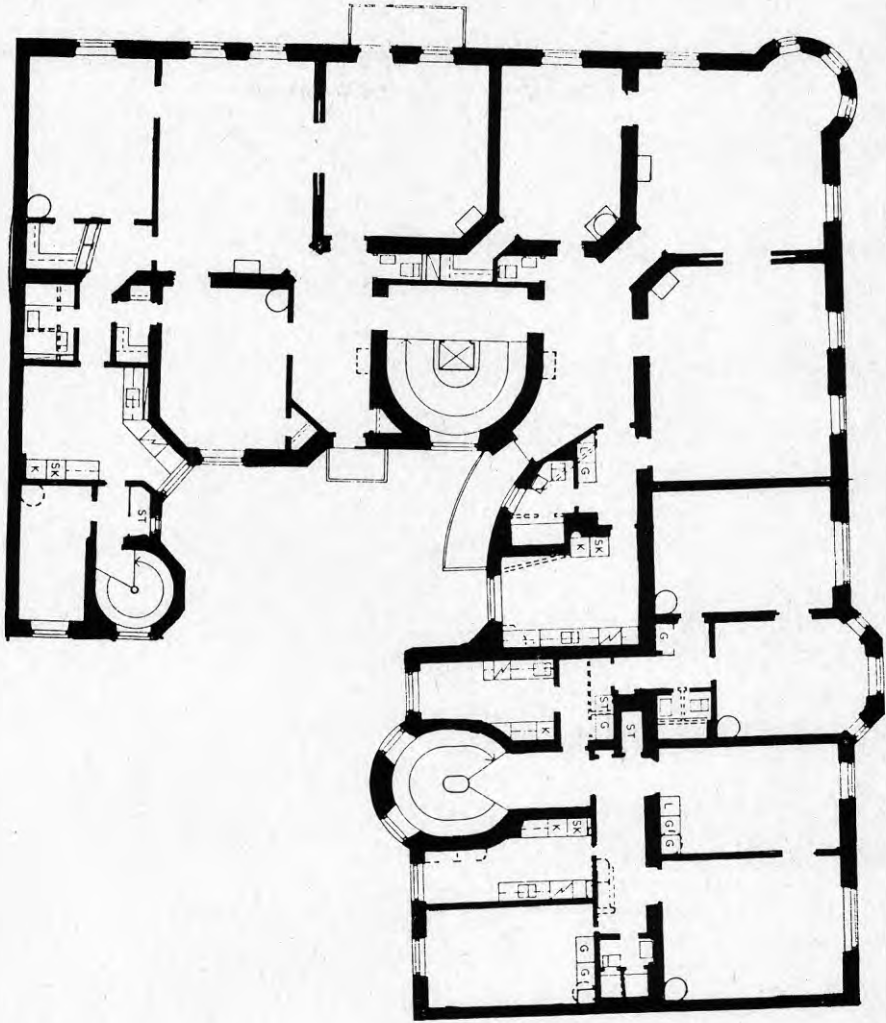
Fikonträdet nr 18. Ombyggnad av typiskt våningsplan
